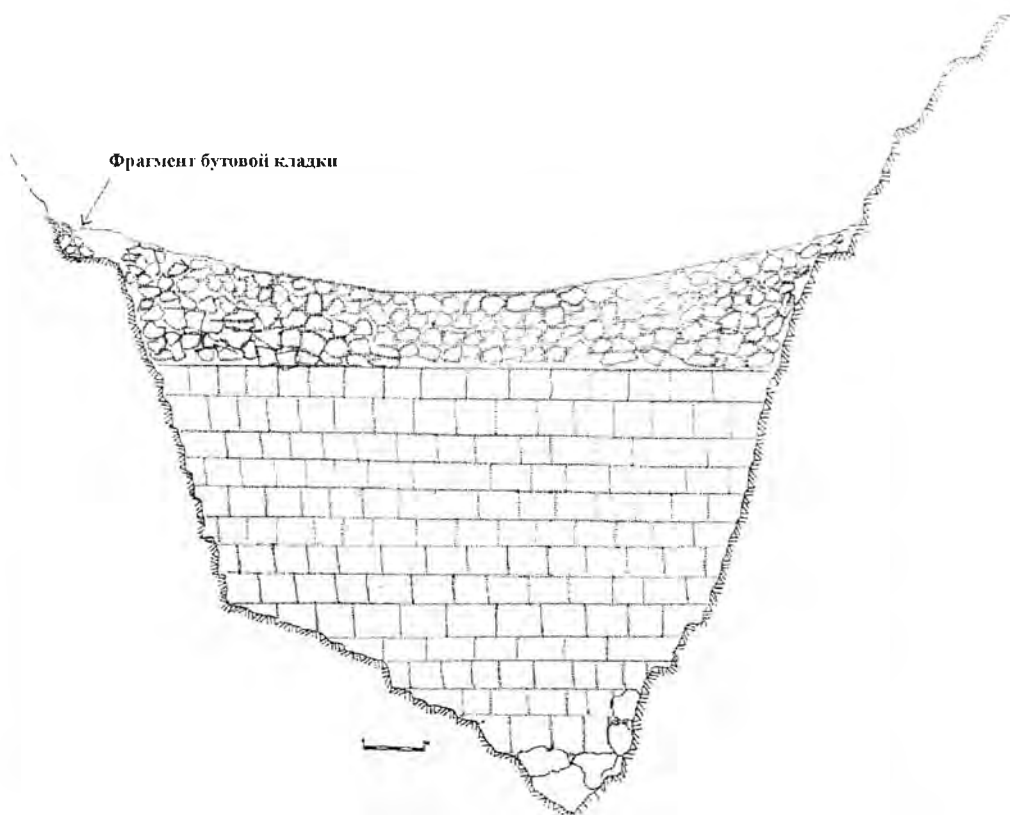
Реконструкция фасада укрепления А.ХІХ, выполненная на основе фотографии Ф.А.Брауна с учетом реальных габаритов устья расселины и данных археологических исследований.
